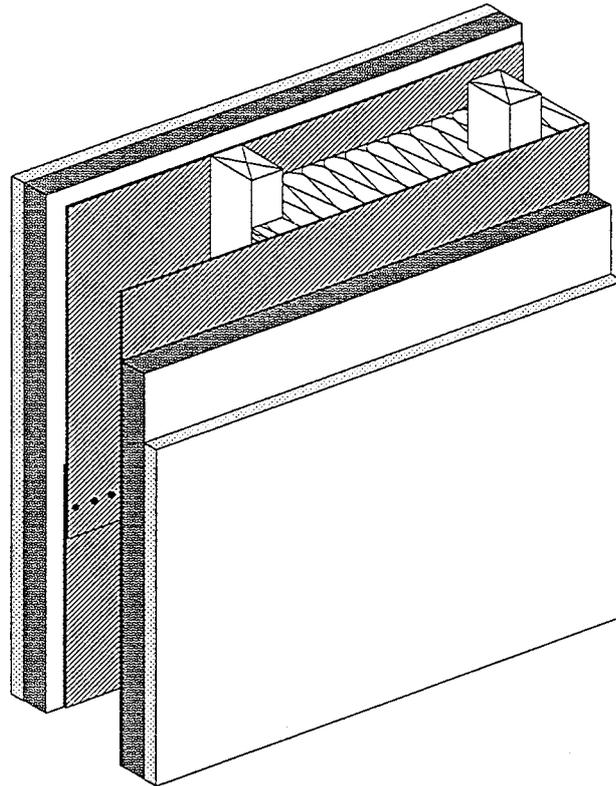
Variante 1 einer "Brandwand" in Trockenbauweise mit Holzunterkonstruktion als Doppelständerwand
